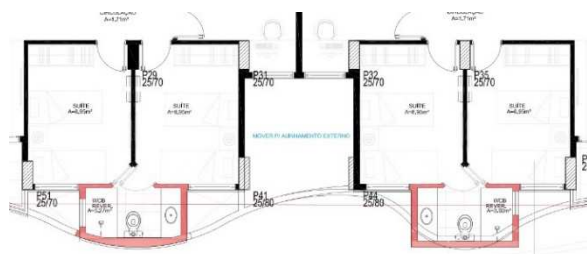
Planta baixa do banheiro reversível das terminações 02 e 03
